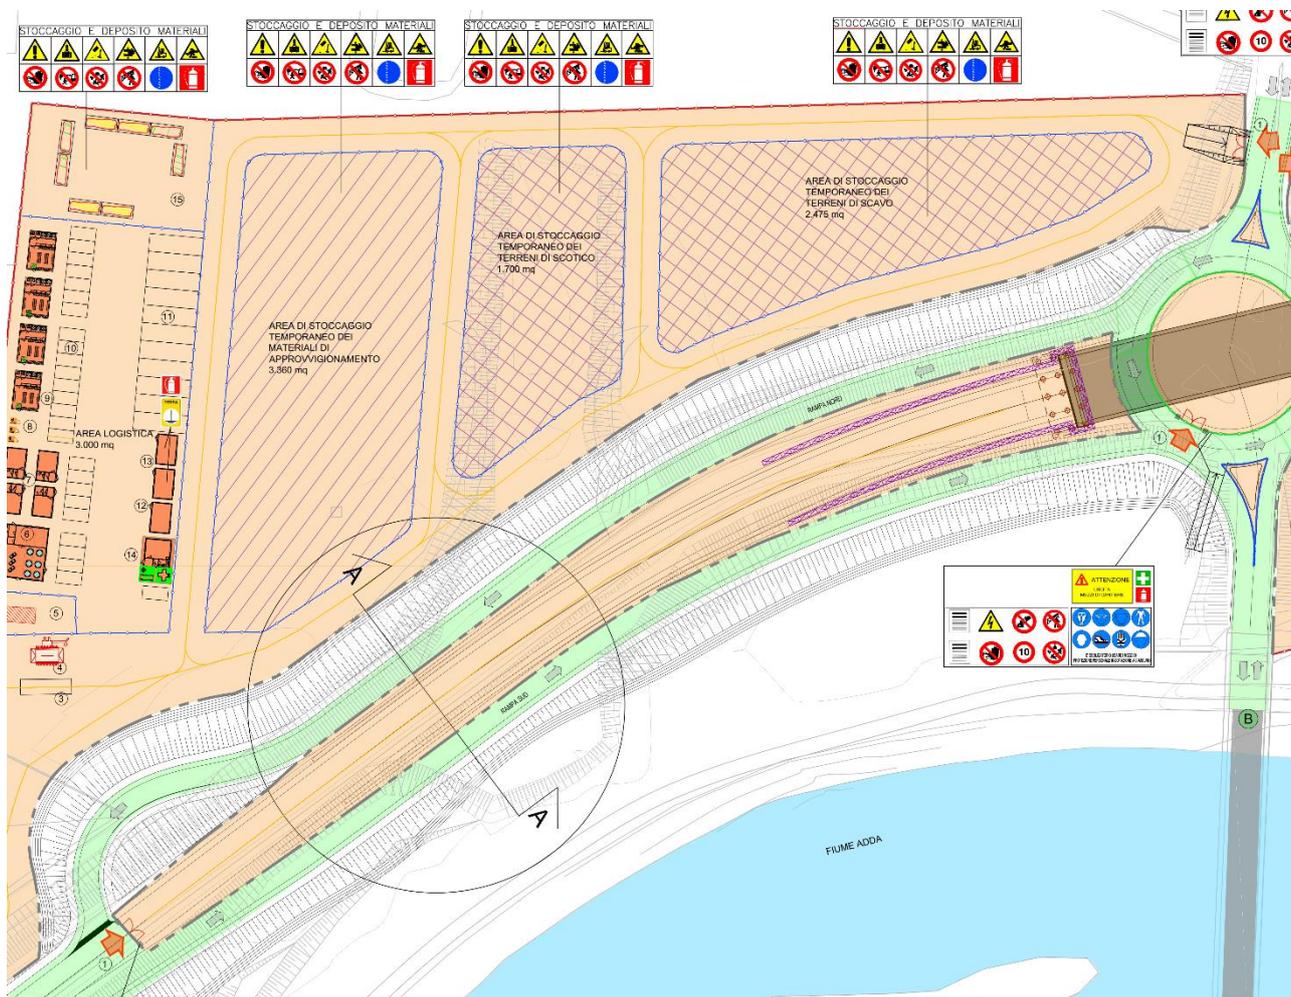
Realizzazione spalla A e muri di contenimento
